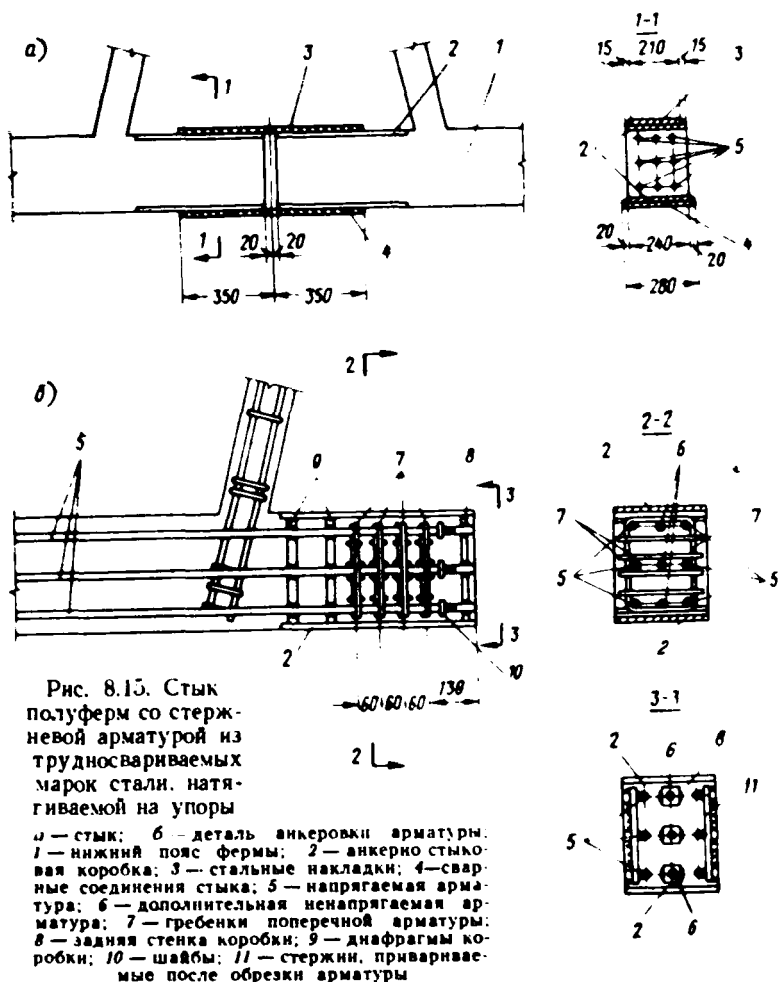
Стык полуфермы со стержневой арматурой из трудносвариваемых марок стали, натягиваемой на упоры
